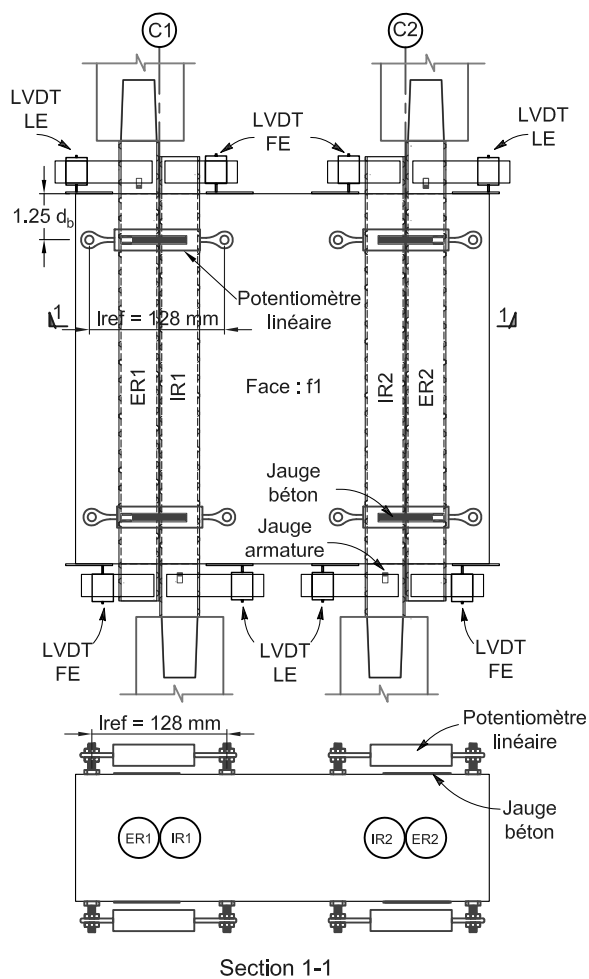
Plan d'instrumentation globale d'un spécimen
